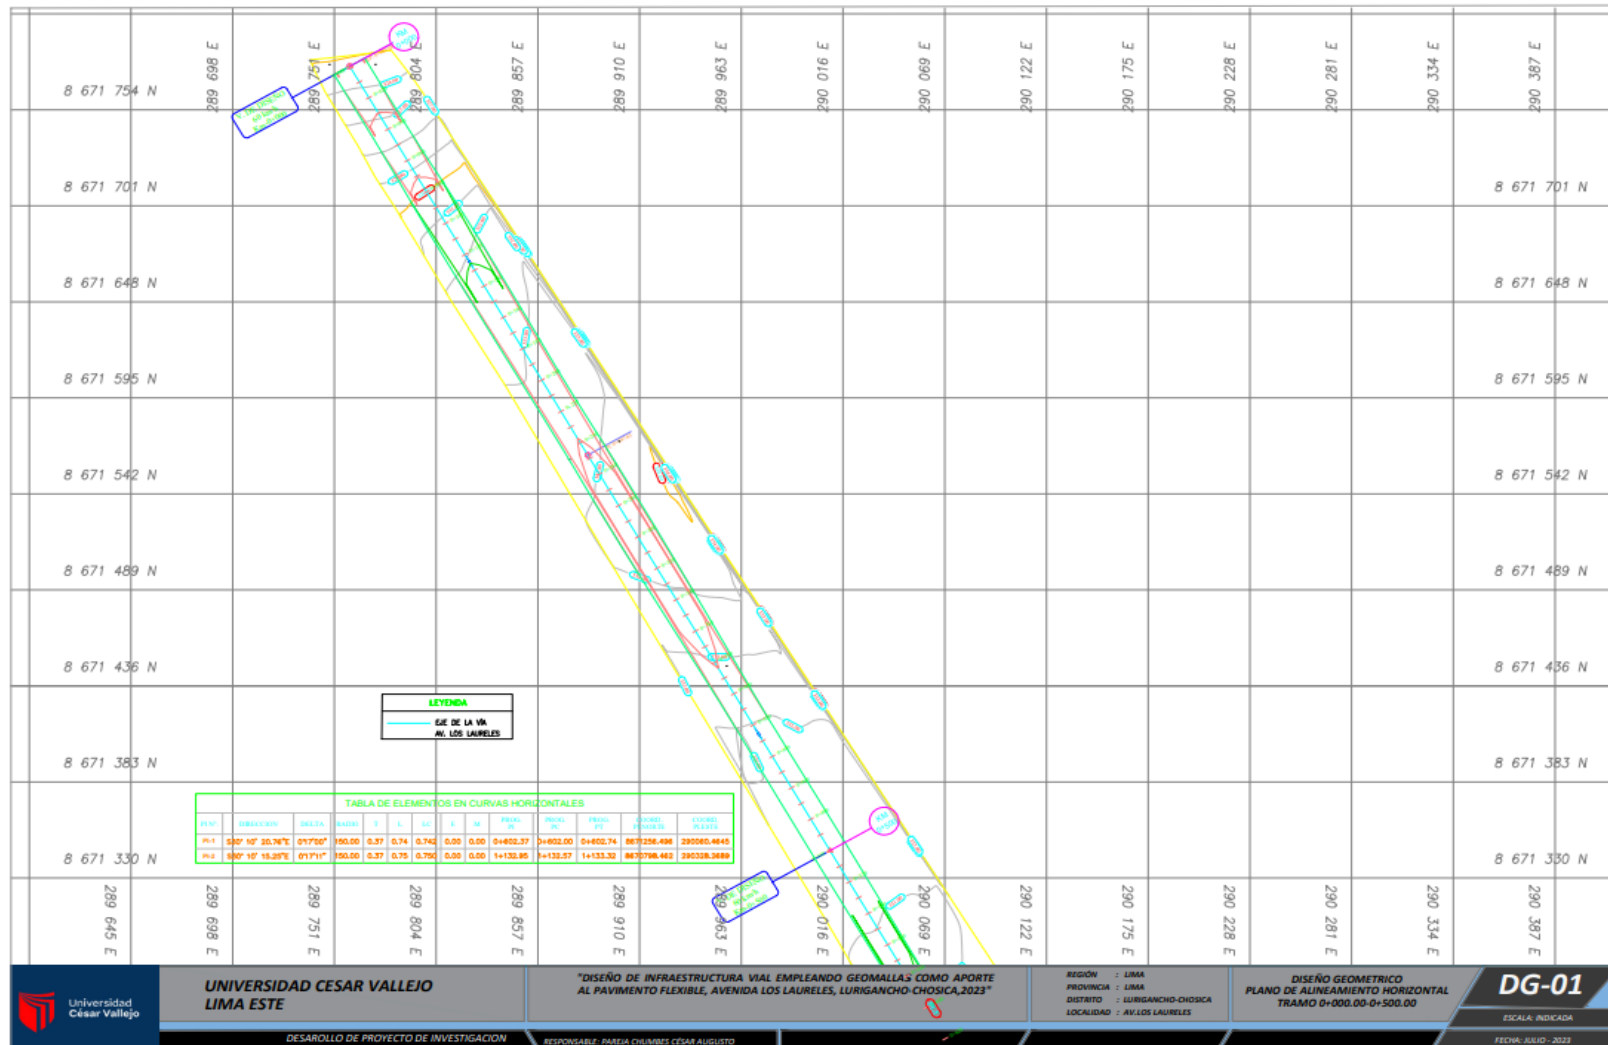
Alineamiento horizontal-Av. Los Laureles
